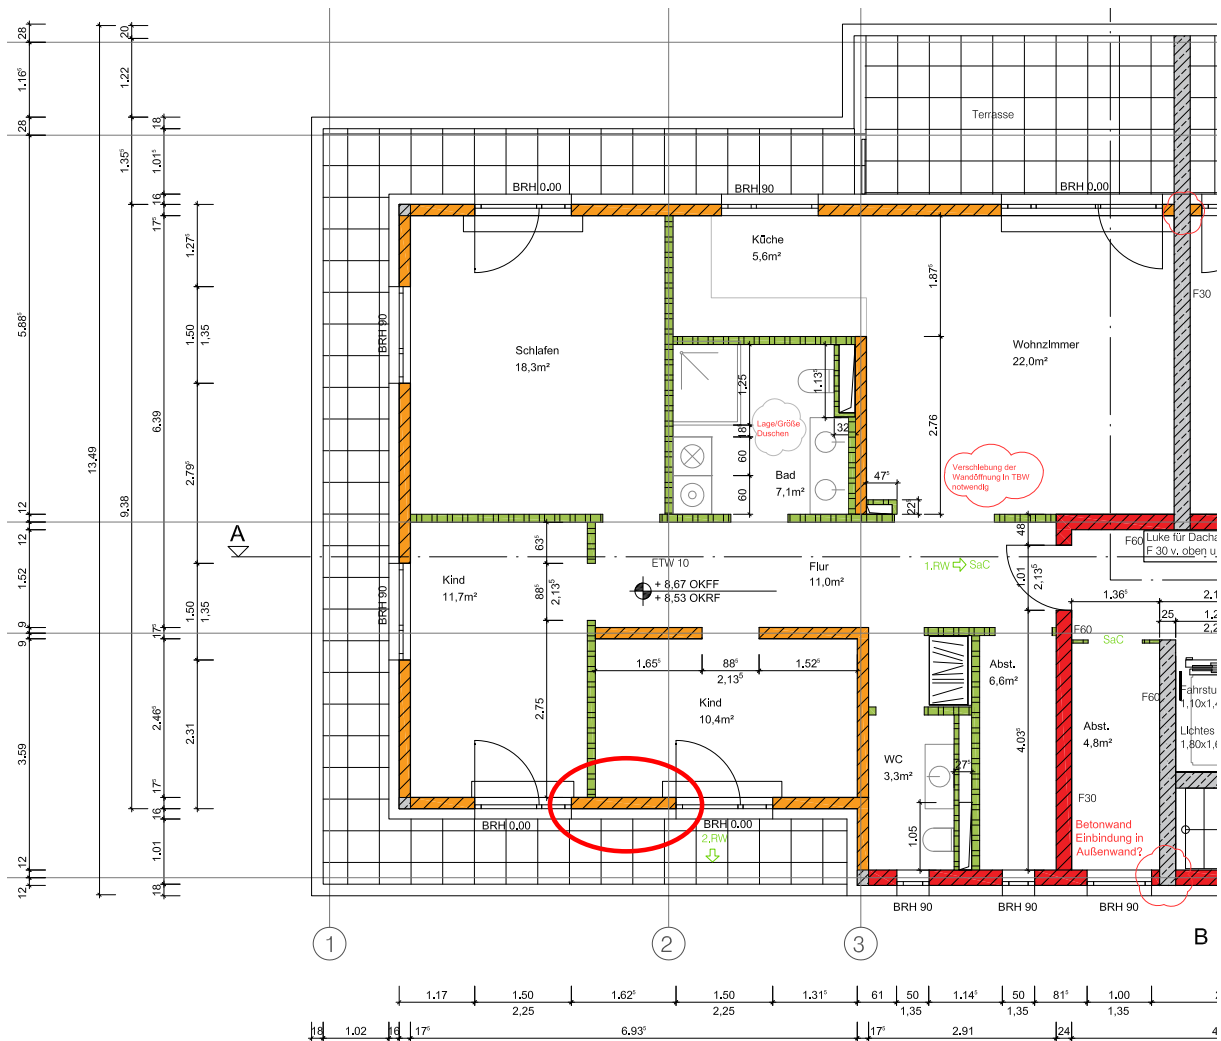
Grundriss des Staffelgeschosses (grün: nichttragende Wände)
